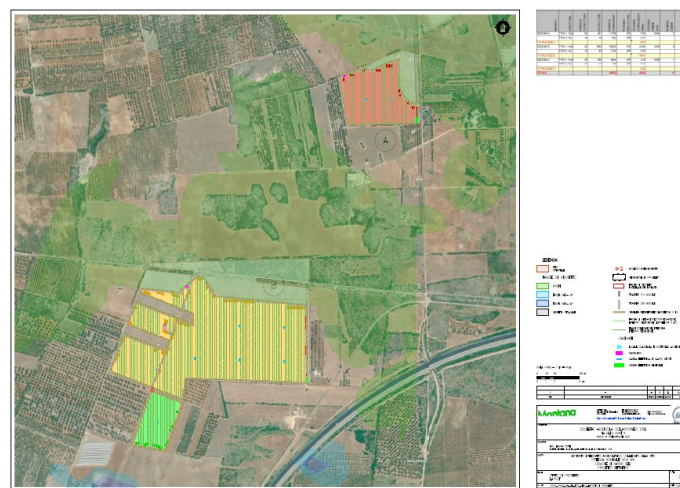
Layout dell'impianto rispetto alle aree boschi
